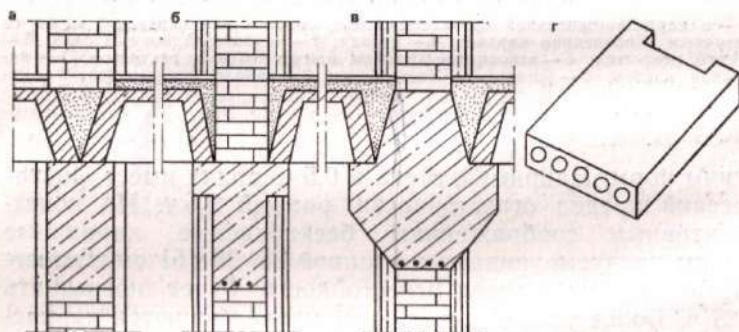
Варианты опирания междуэтажных перекрытий на каркасные противопожарные стены
